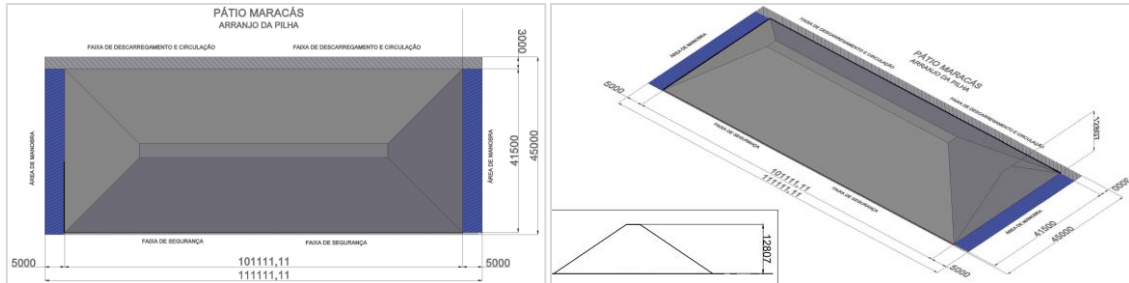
CONSTRUÇÃO DO PÁTIO.
